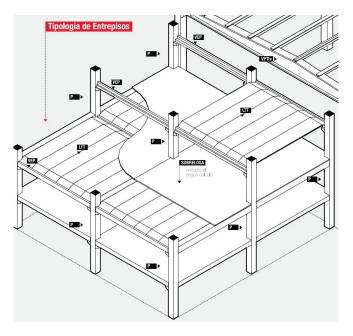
Ilustración de sistema constructivo mediante elementos prefabricados de Hormigón . Fuente: Catálogo Tensocret.
